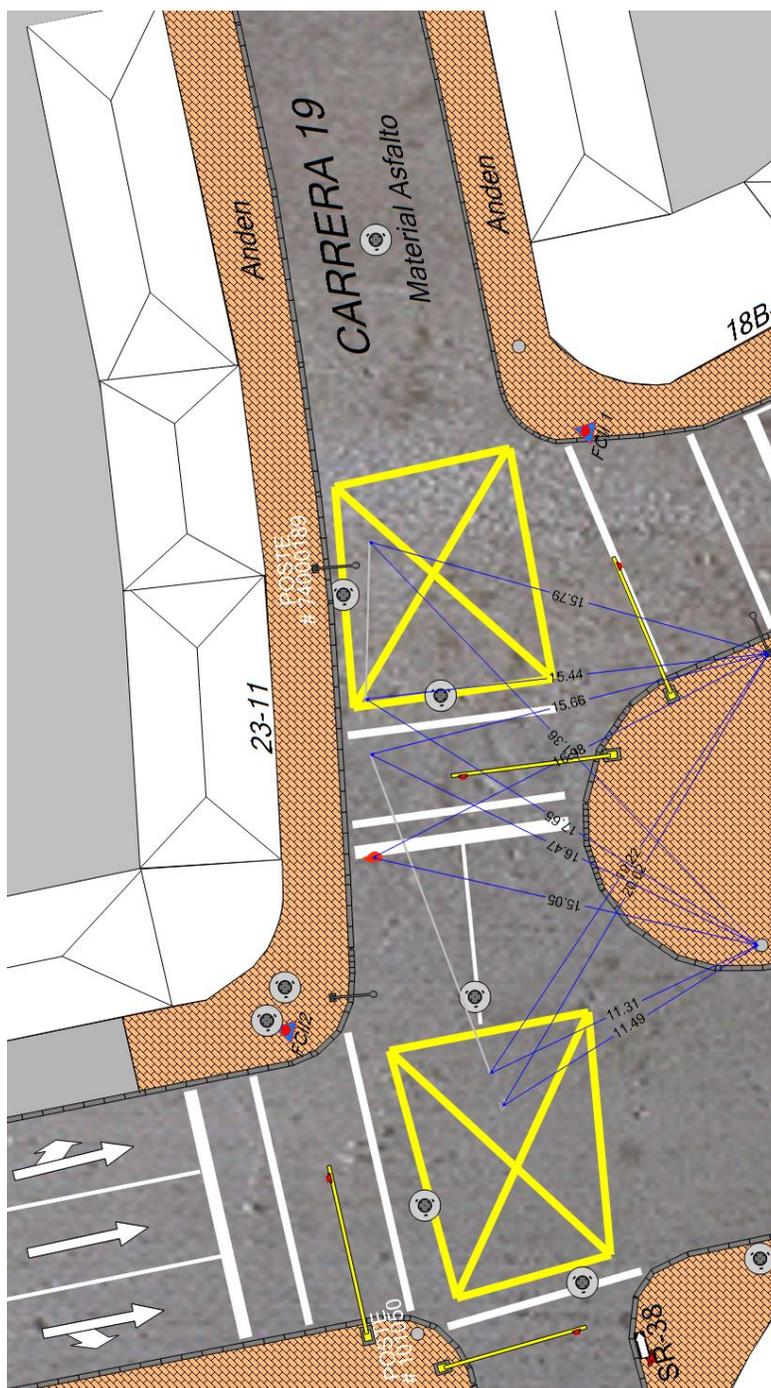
Detalle de la fijación plasmada en el Plano Topográfico 24925.
